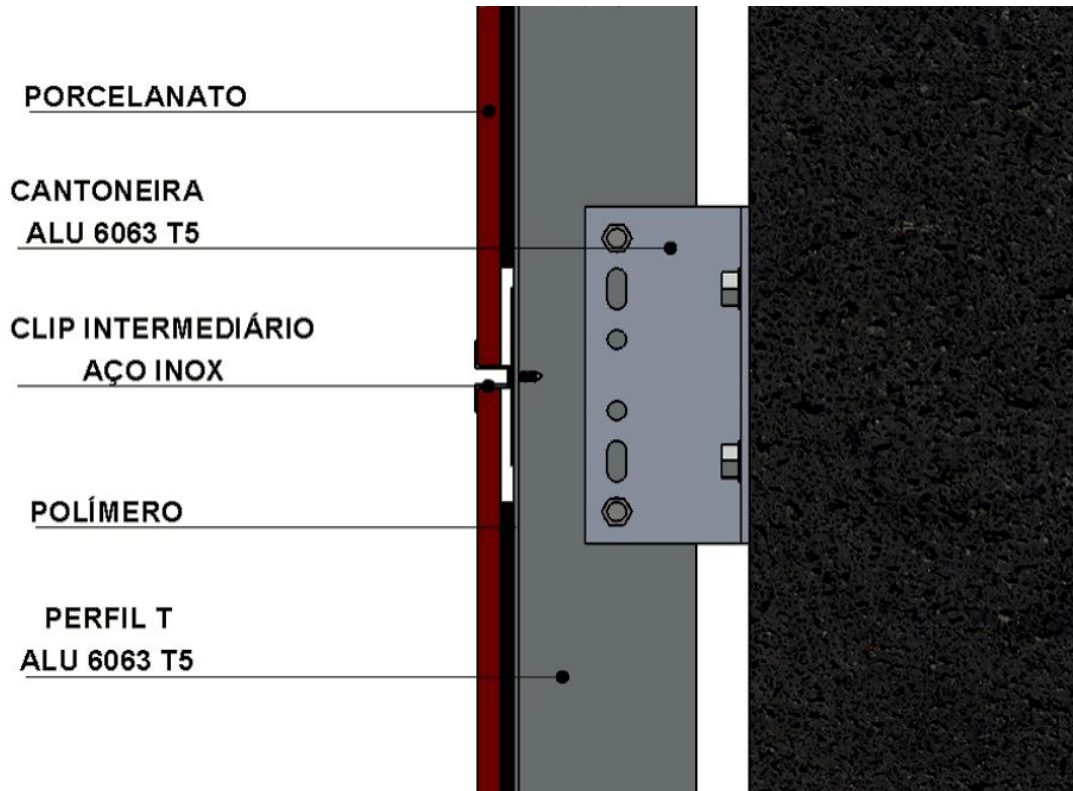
Detalhe fachada ventilada SEBRAE-ES
